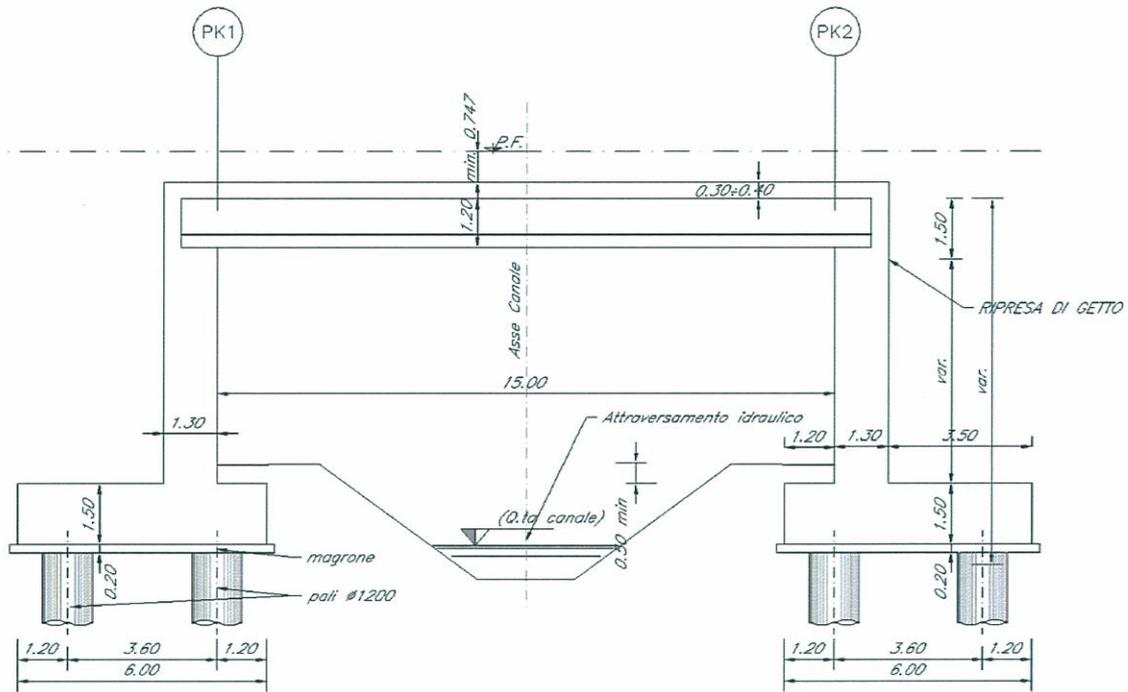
Prospetto in corrispondenza di attraversamento idraulico.
